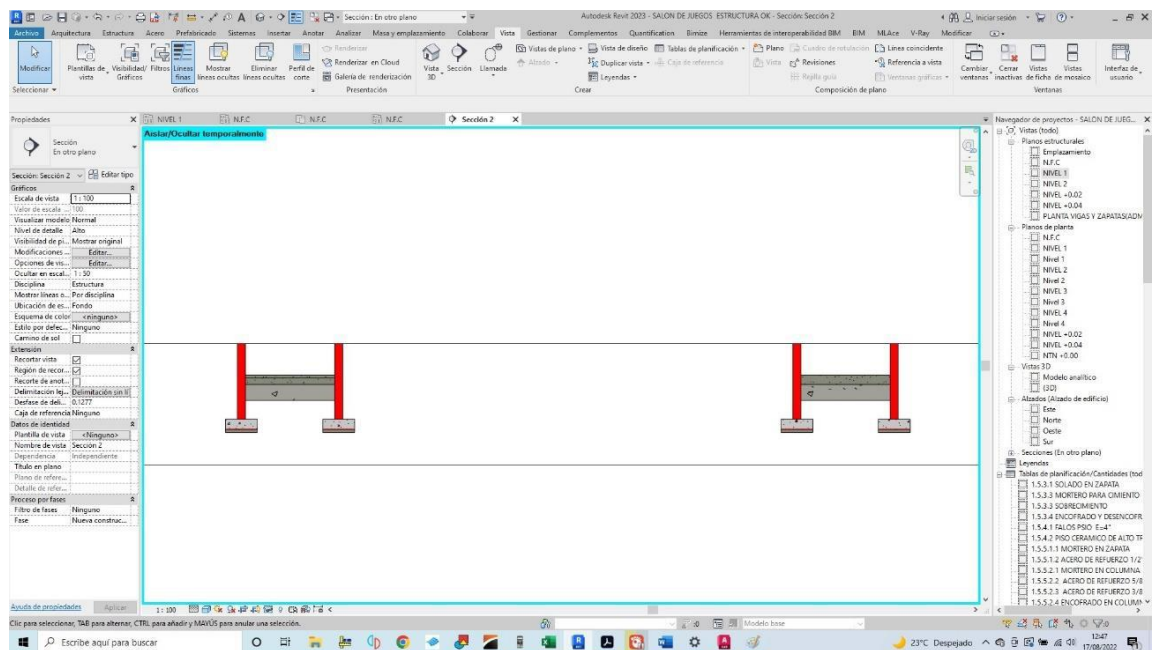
Elevación Frontal, vista de zapatas y cimentación corrida.
